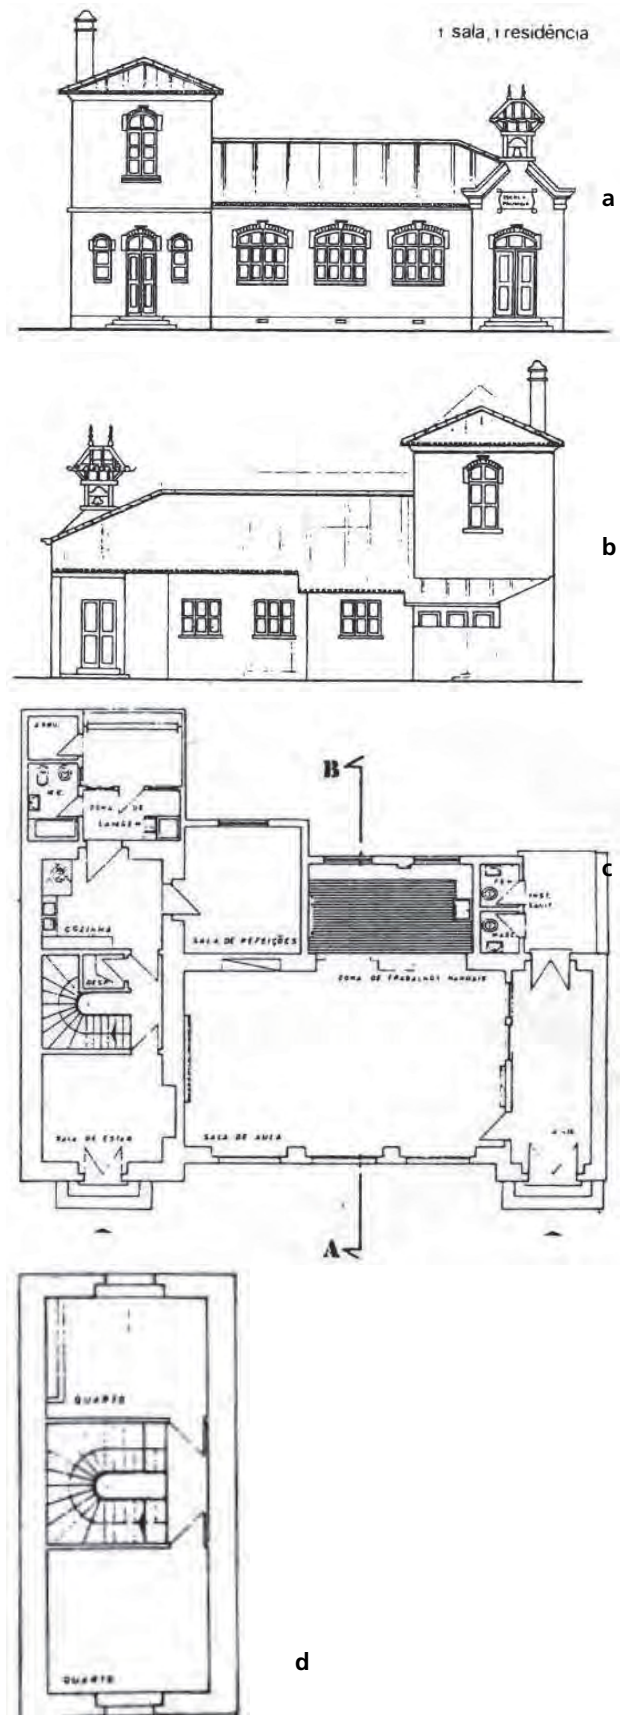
a - Alçado principal; b - Alçado posterior; c - Planta do 1º piso; d - Planta do 2º piso.
